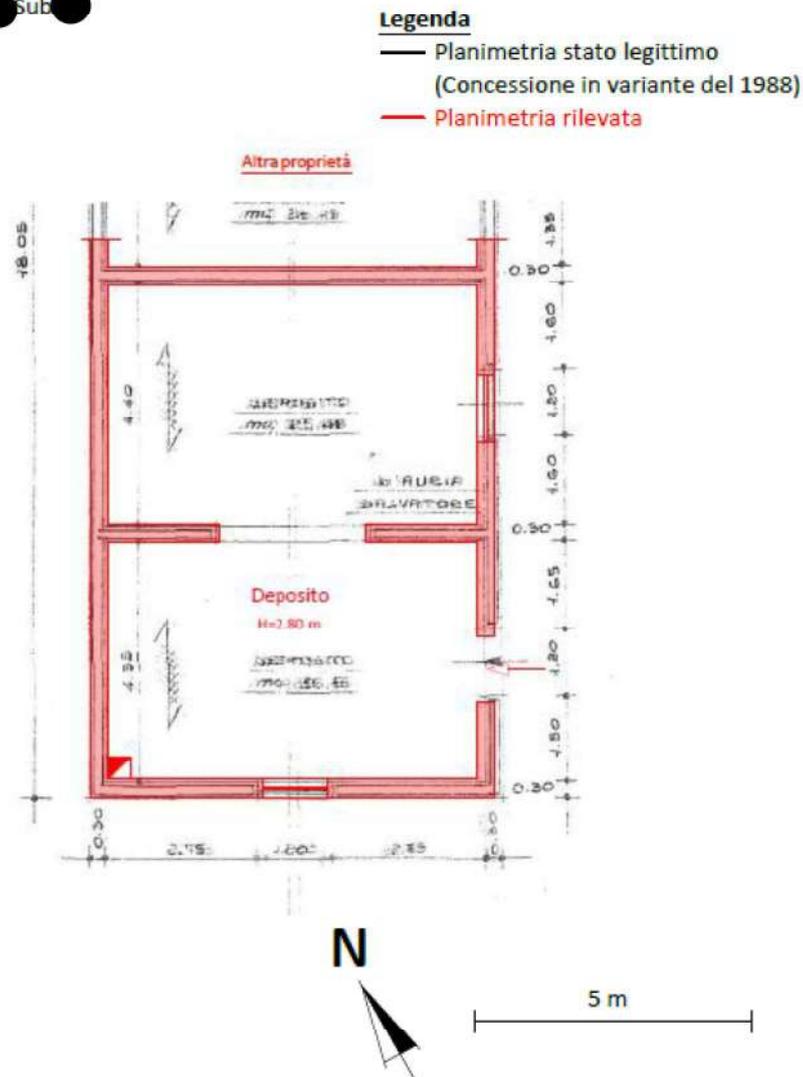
Sovrapposizione stato reale dei luoghi e progetto autorizzato - Planimetria piano terra del deposito (F. ■ p.lla ■ sub. ■)
